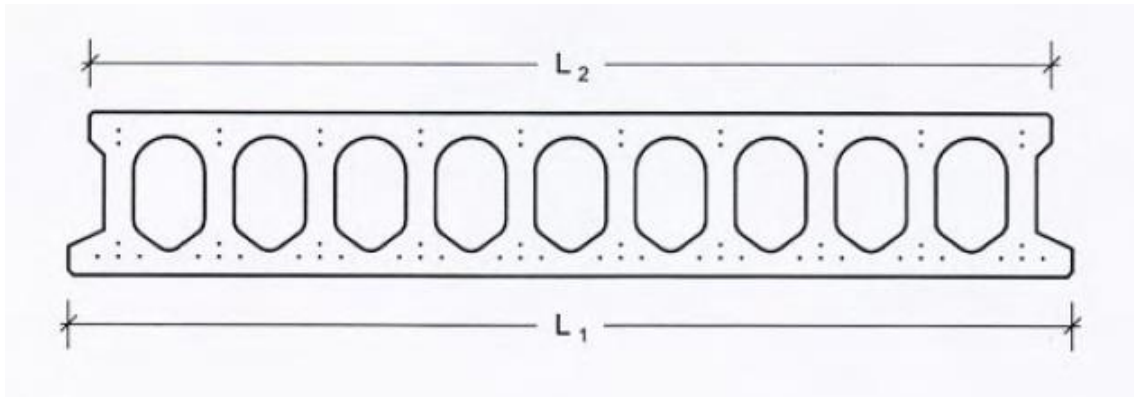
Detalle del perfil de la placa alveolar. Fuente: Ficha de características técnicas – según EFHE – del forjado de losas alveolares pretensadas (PREFORSA).
